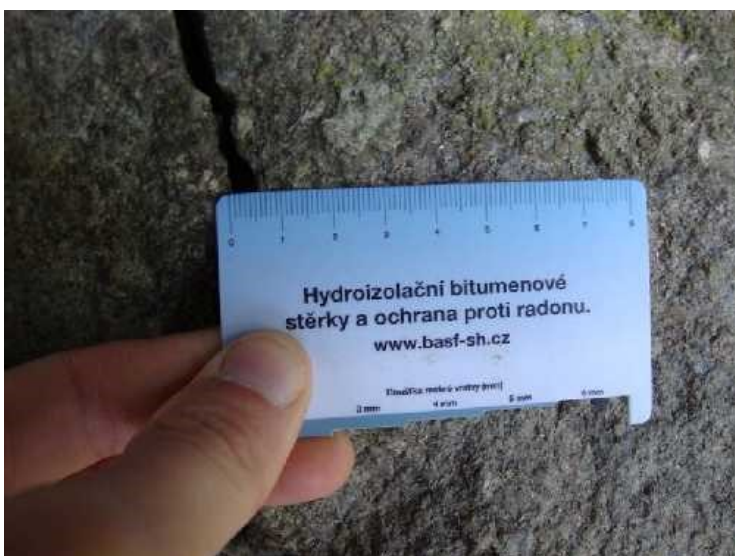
Degradované povodní křídlo levobřežní opěry.
